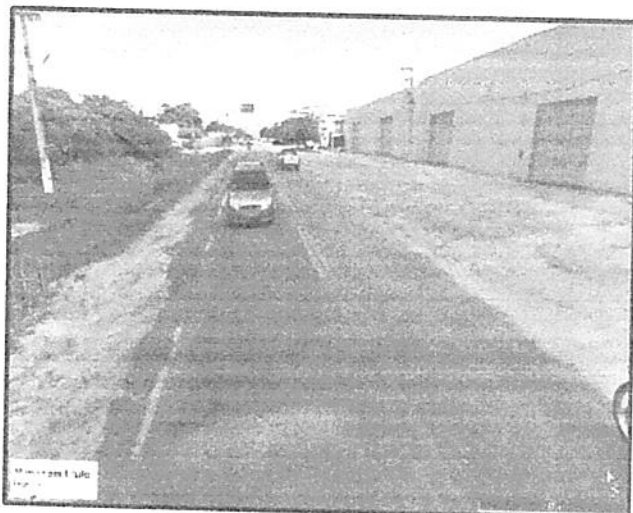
fissuras na pista, acostamento danificado.
